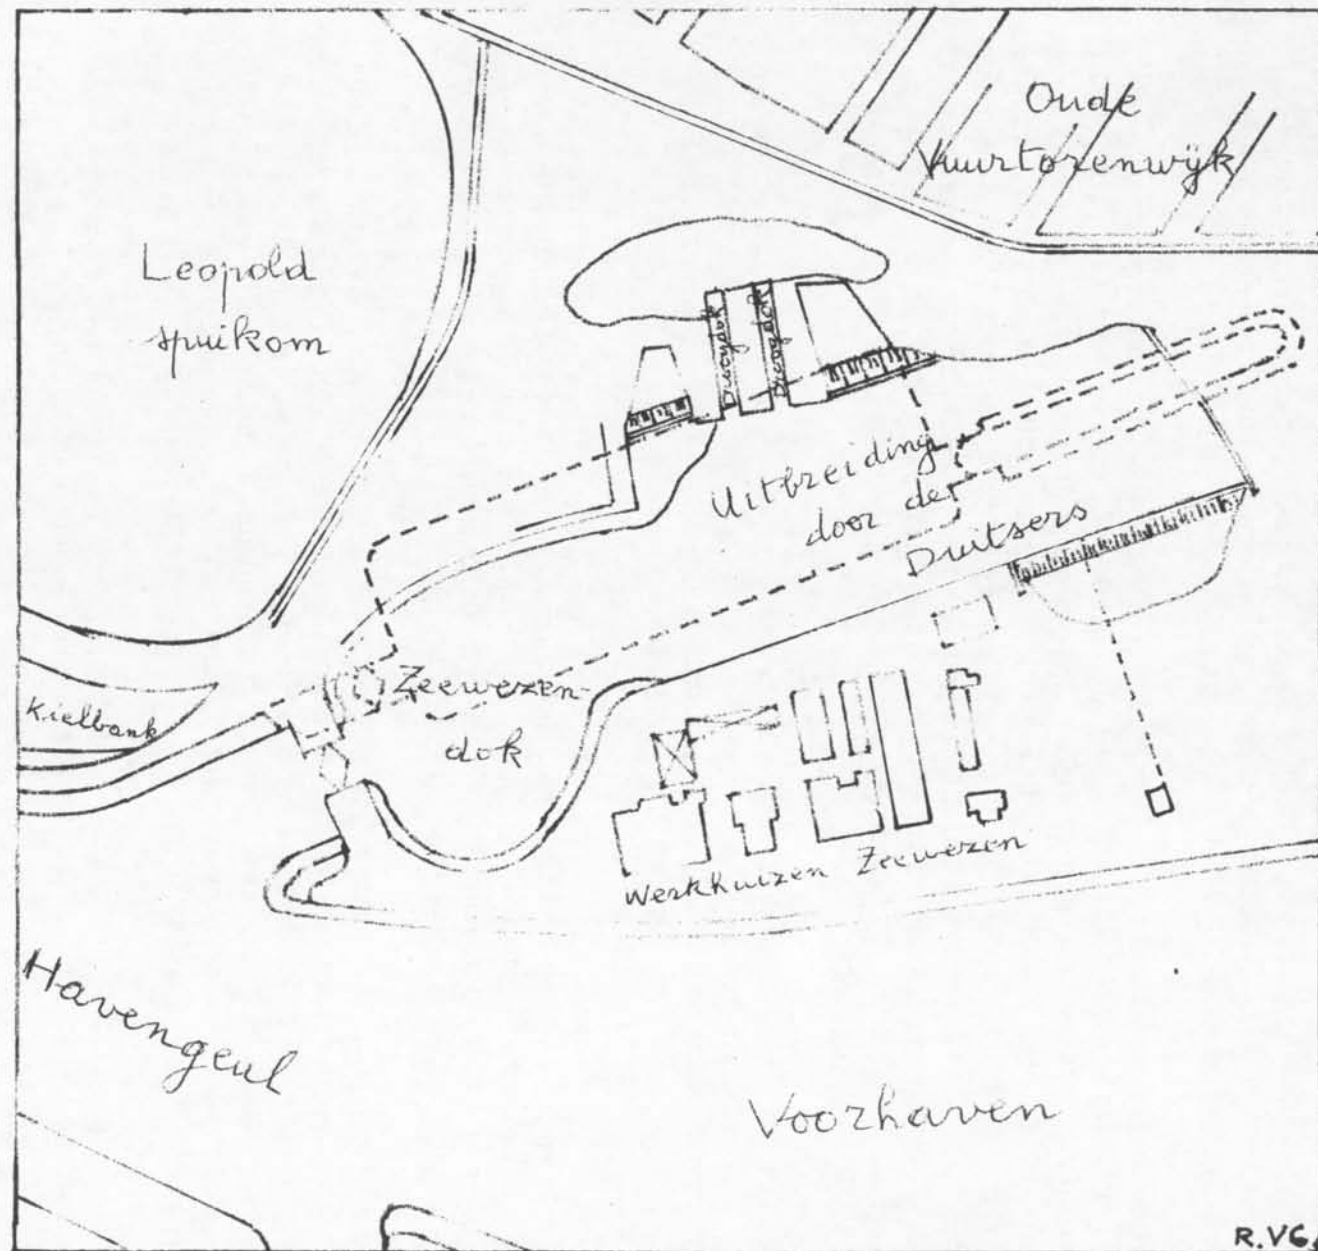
Plan opgemaakt in juni 1919 door hoofdingenieur Verstraete met de installaties van het Zeewezen zoals zij door de Duitsers in 1915-1918 werden uitgebouwd.
